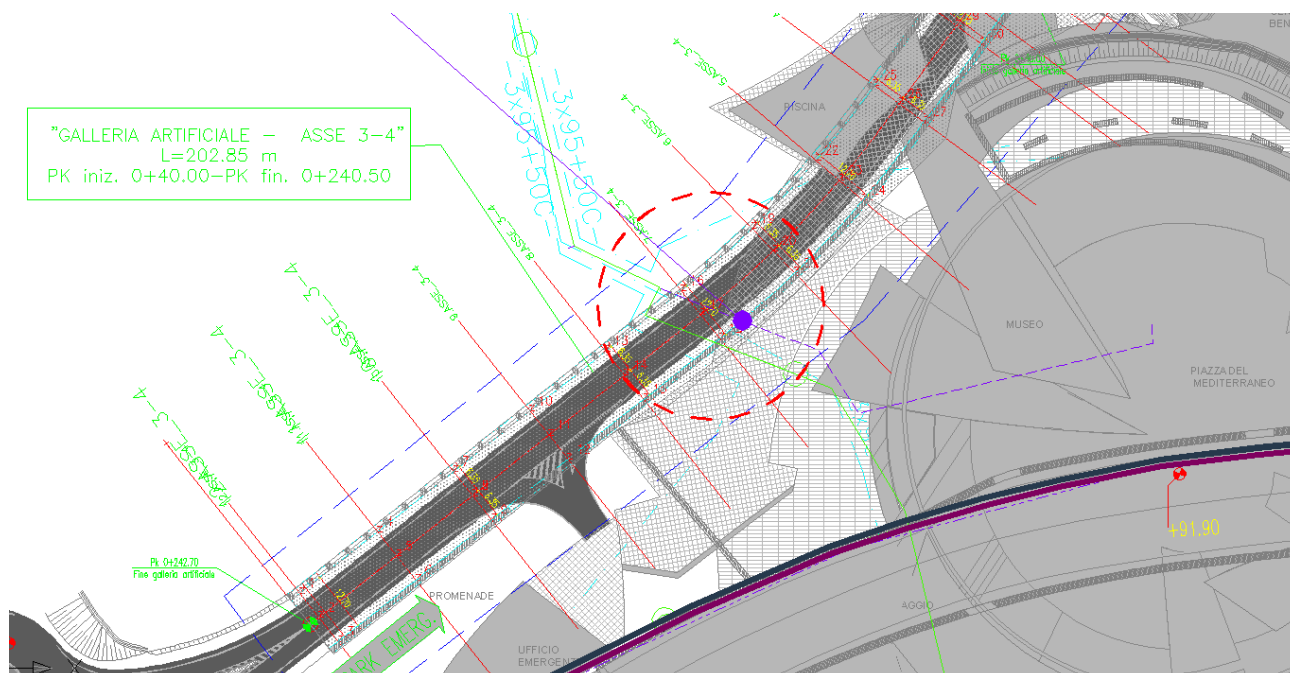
Stralcio planimetrico con l'individuazione delle interferenze
